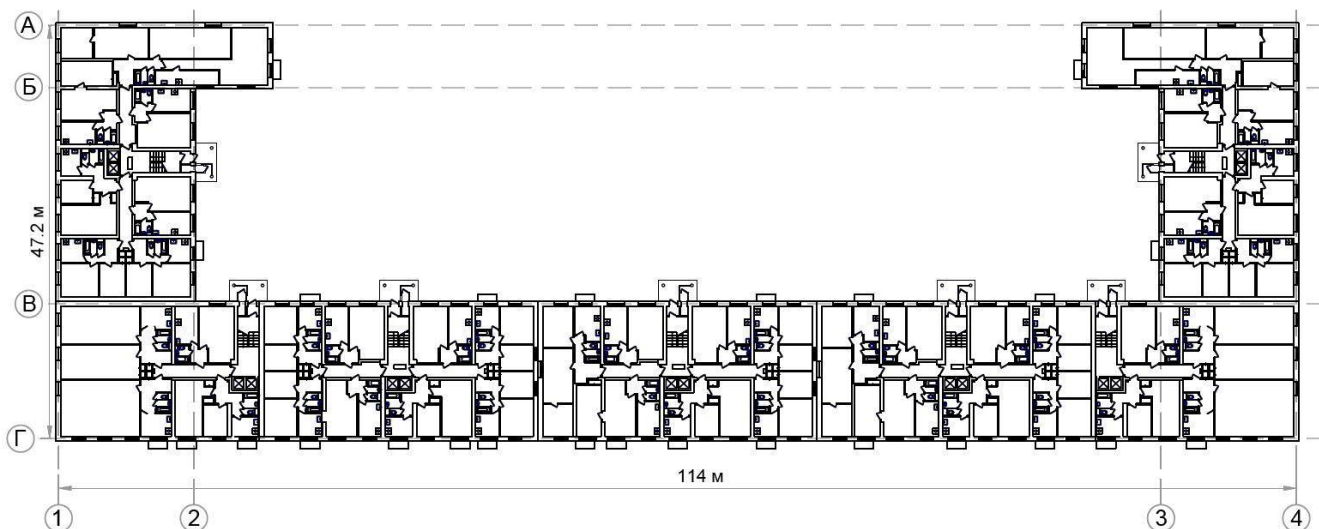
План подвального этажа зданий по адресам: г. Москва, Ленинский проспект, дом 83
